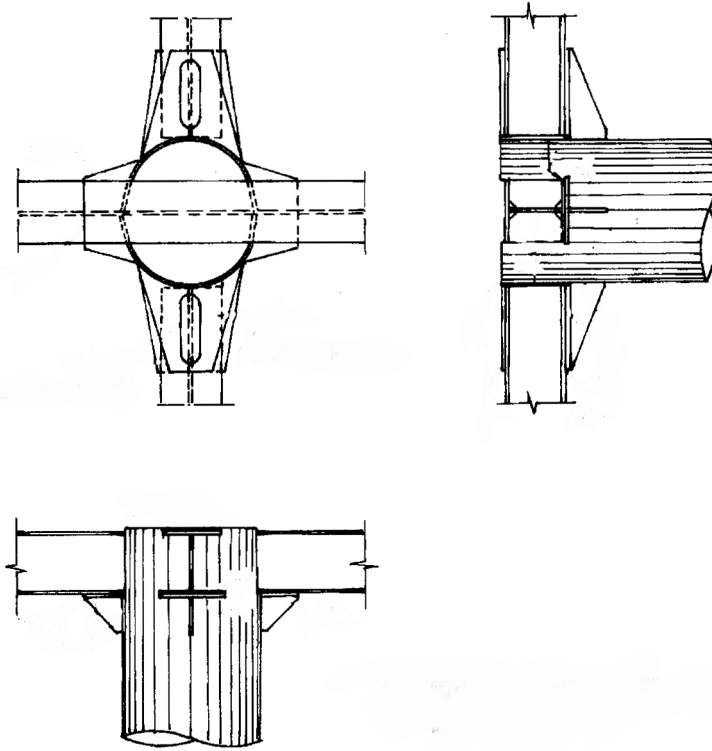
鋼筋混凝土結構樁頭接合圖例
